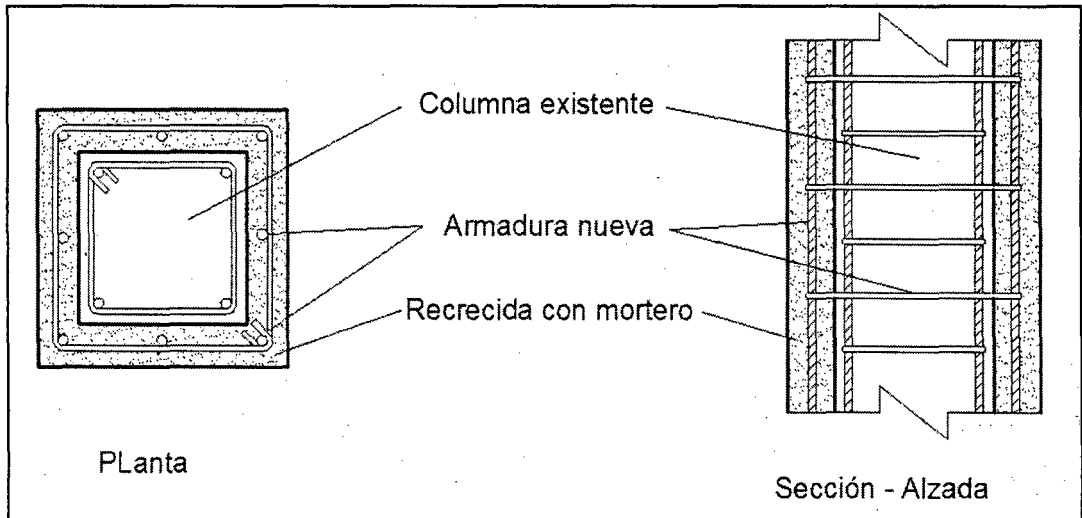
Recrecido con concreto armado por adherencia.
